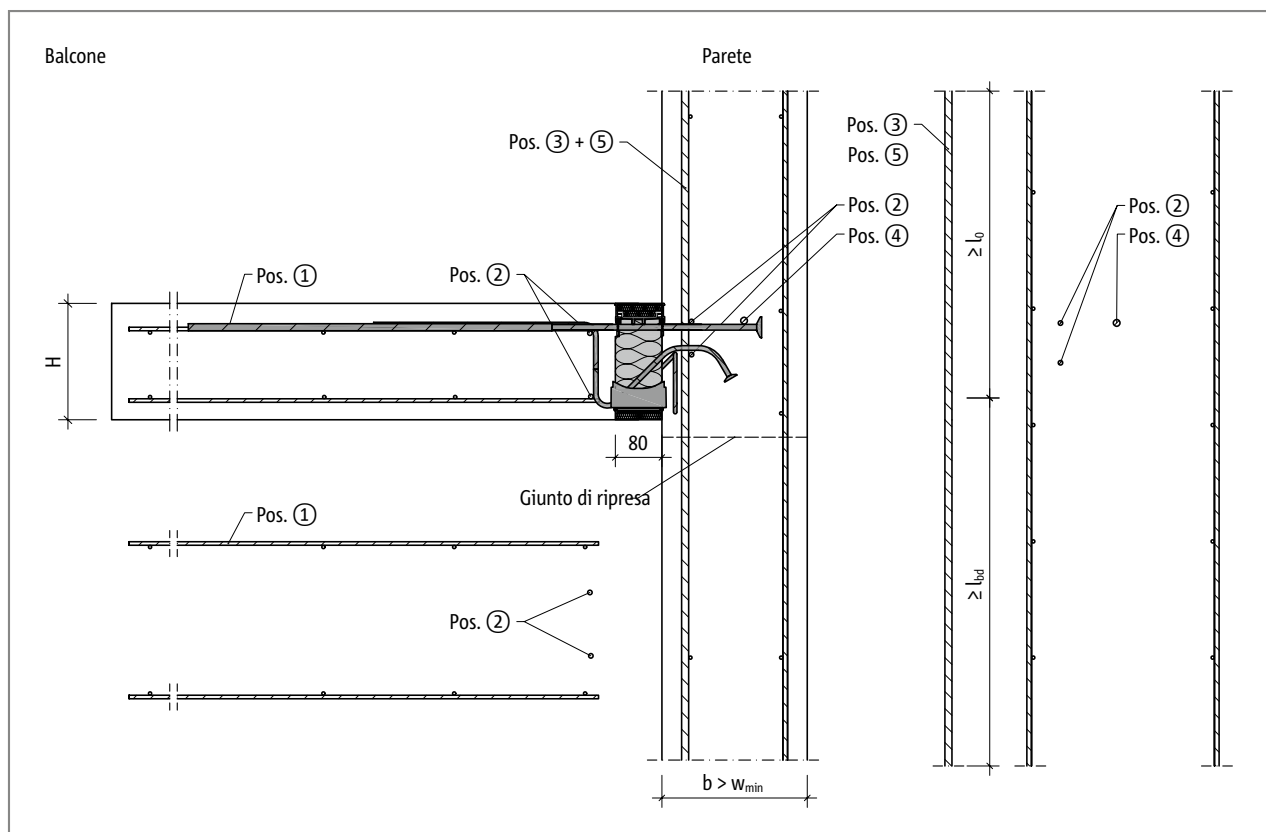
Schöck Isokorb® T tipo KL-U: armatura in opera del raccordo alla parete con dimensione superiore dell'elemento ( $w_{eff} > w_{min}$ )
